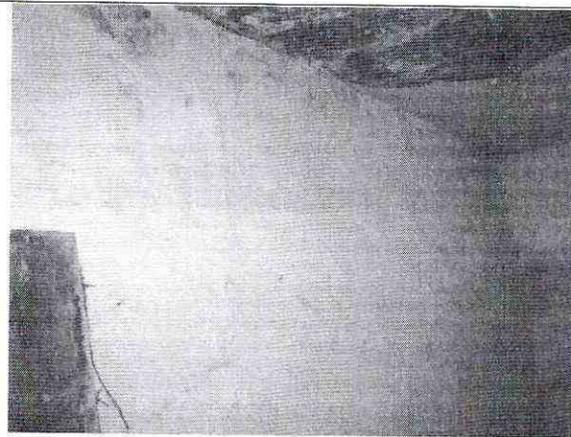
Fisuras y agrietamientos en muros internos.
